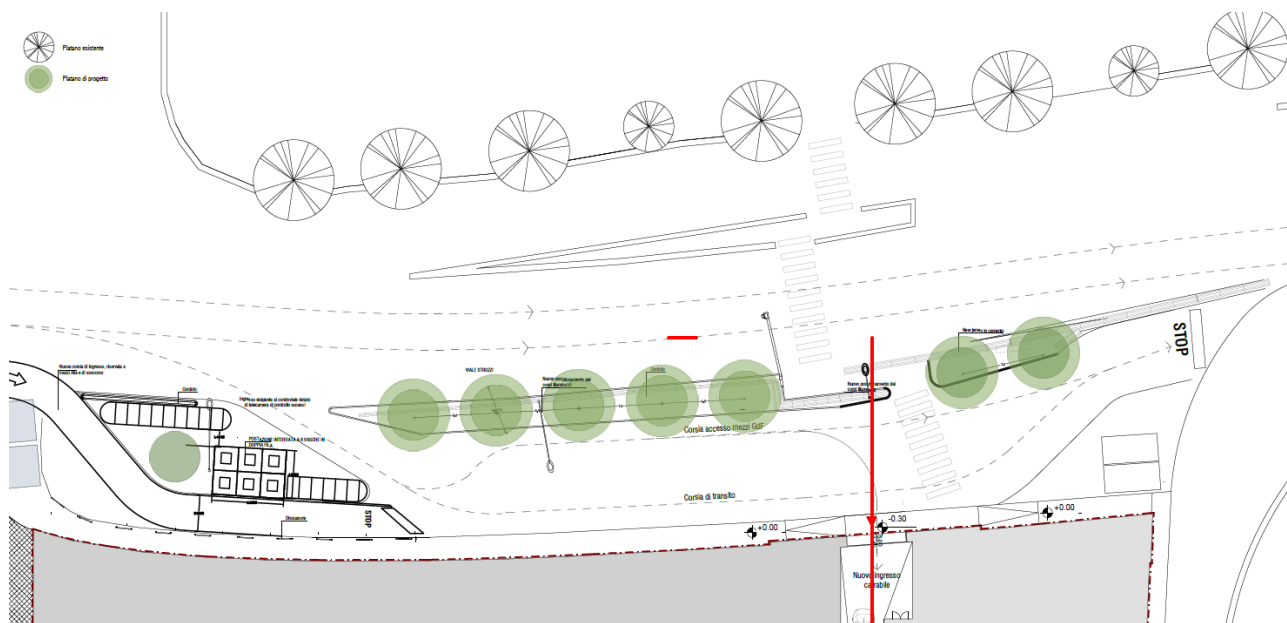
schema planimetrico dell'area a parcheggio su viale Strozzi
